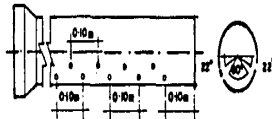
SECCION TRANSVERSAL DE SUBDREN.
